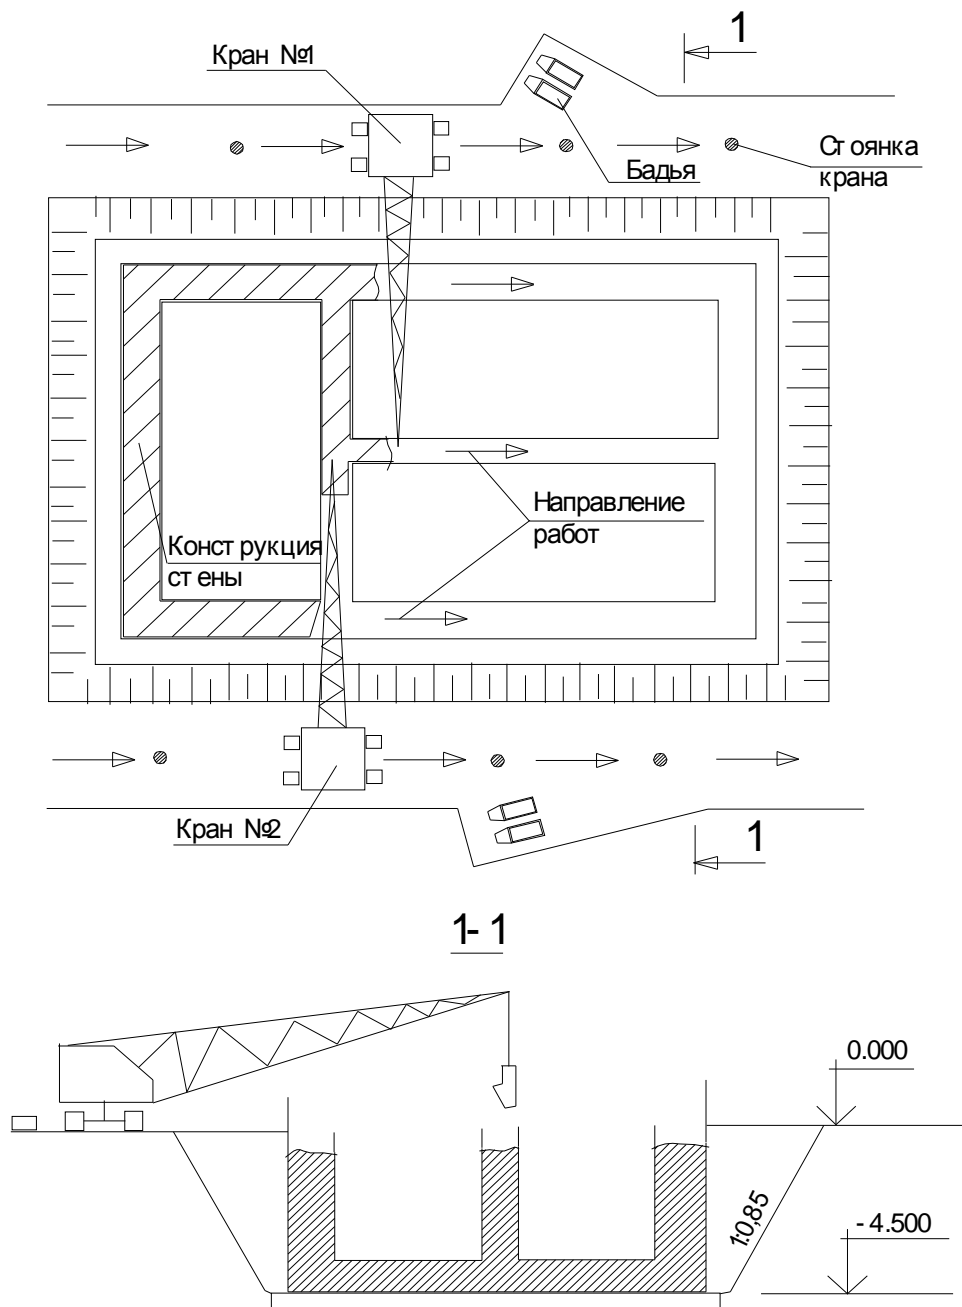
Технологическая схема бетонирования стен двумя кранами
